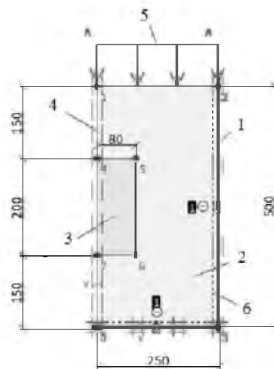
Расчетная схема / Design model: 1 – стенки грунтового лотка / wall of ground tank; 2 – грунтовое основание / earth foundation; 3 – кластер цементного камня / cement stone cluster; 4 – инъектор / injector; 5 – нагрузка / load; 6 – интерфейс / interface
